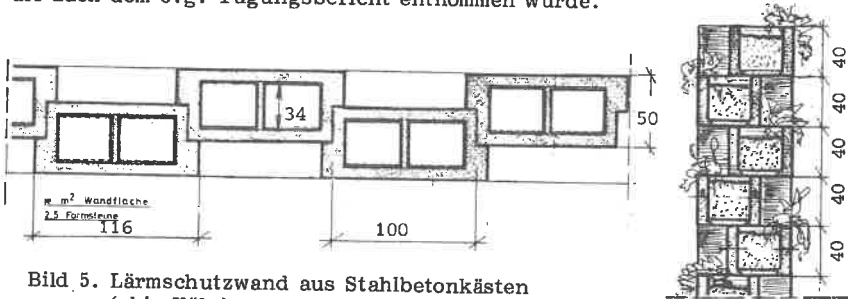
Lärmschutzwand aus Stahlbetonkästen
